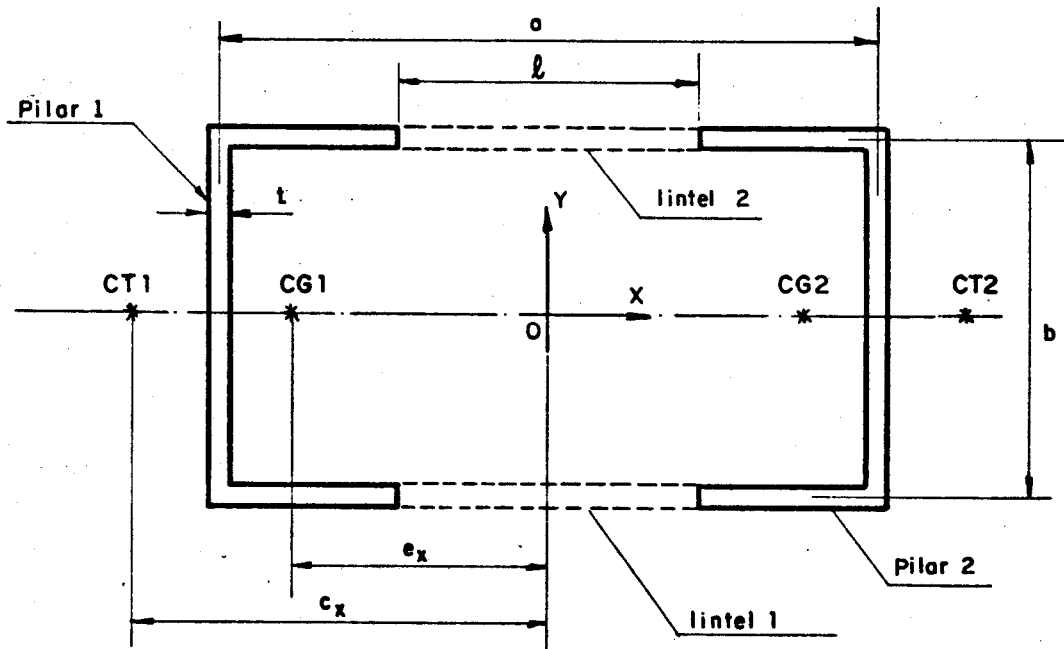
PLANTA DO NÚCLEO ESTRUTURAL
